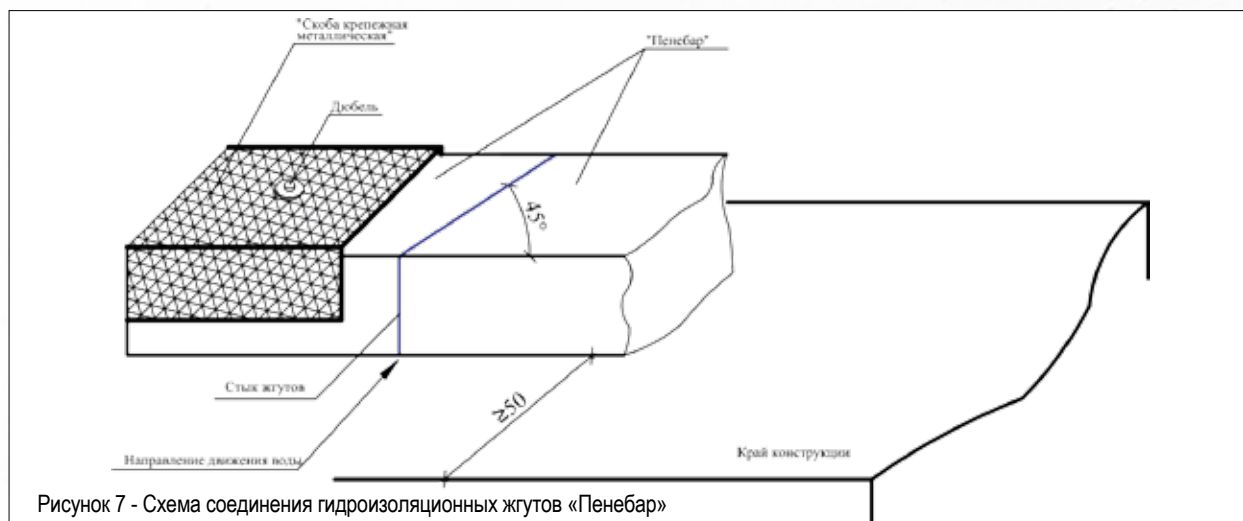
Схема соединения гидроизоляционных жгутов «Пенебар»
